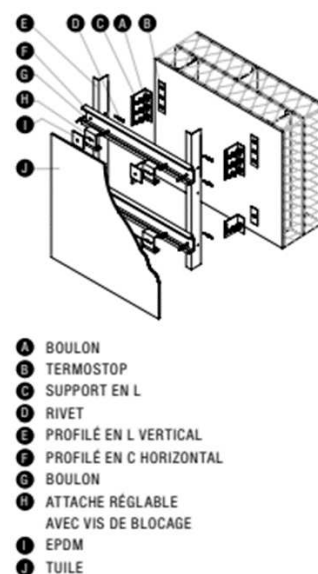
Système de fixation d'une façade ventilée en céramique IT-S
